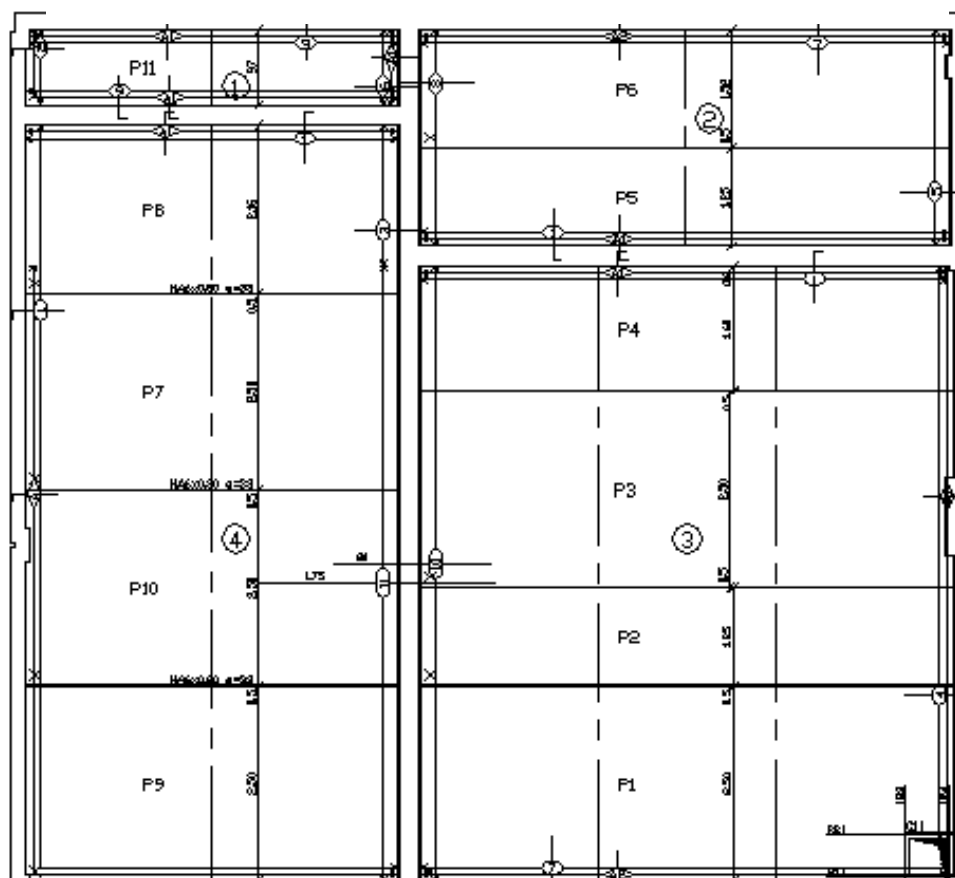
PLAN DE POSE DES PREDALLES JOINT 23 PH R+2
